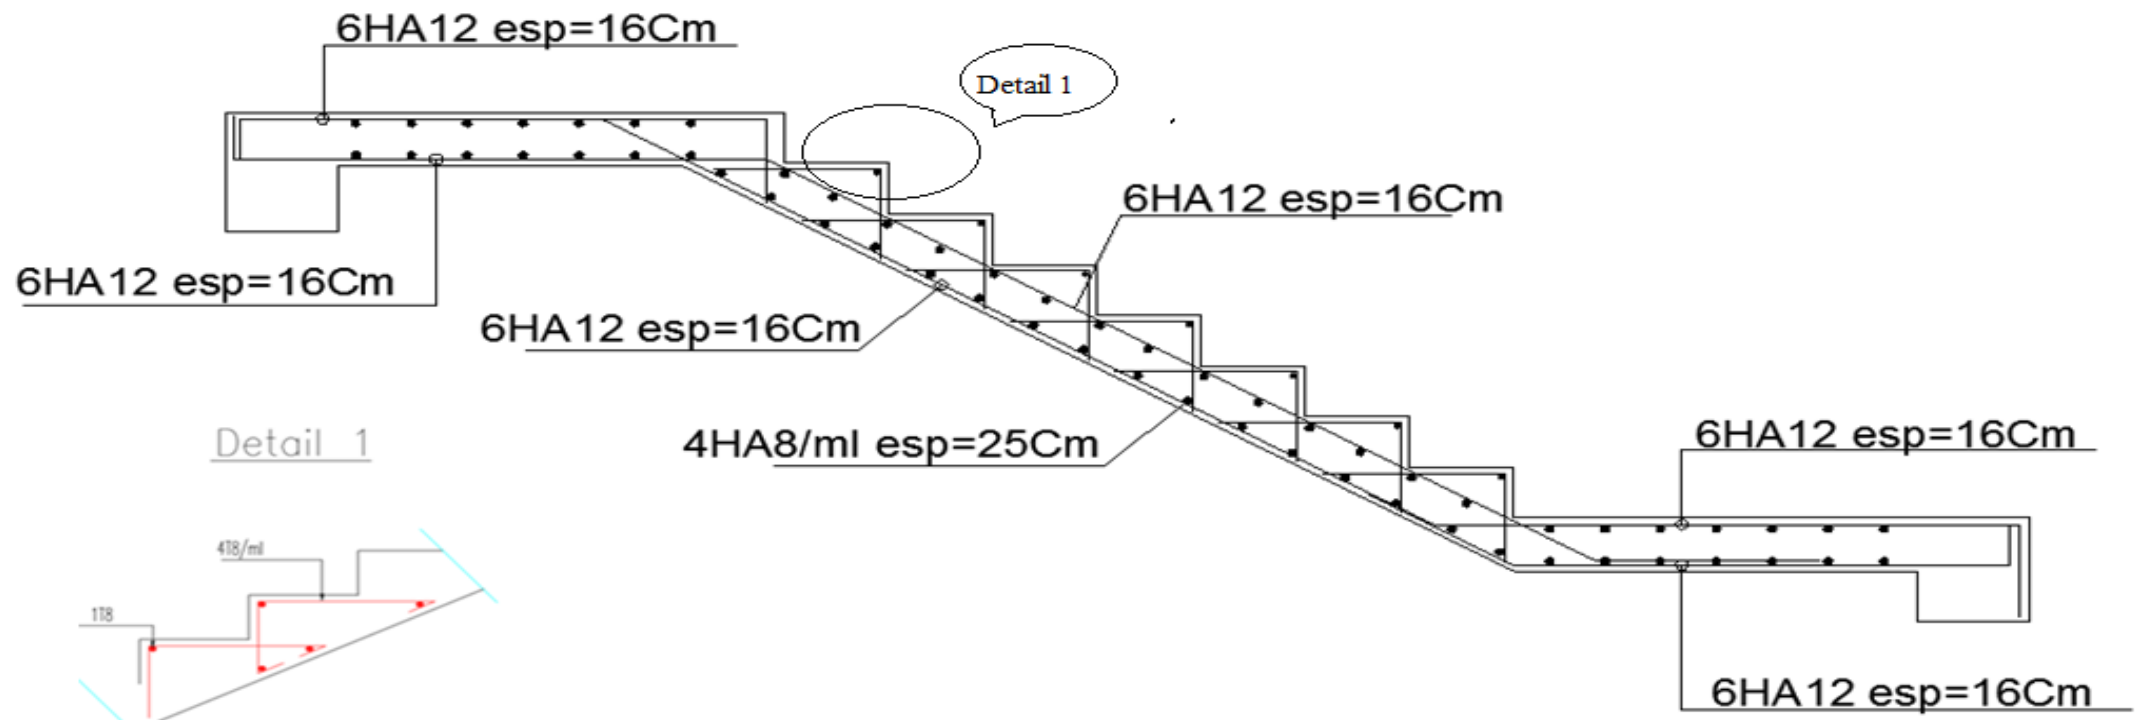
Ferrailage de l'escalier -1- du R.D.C.
